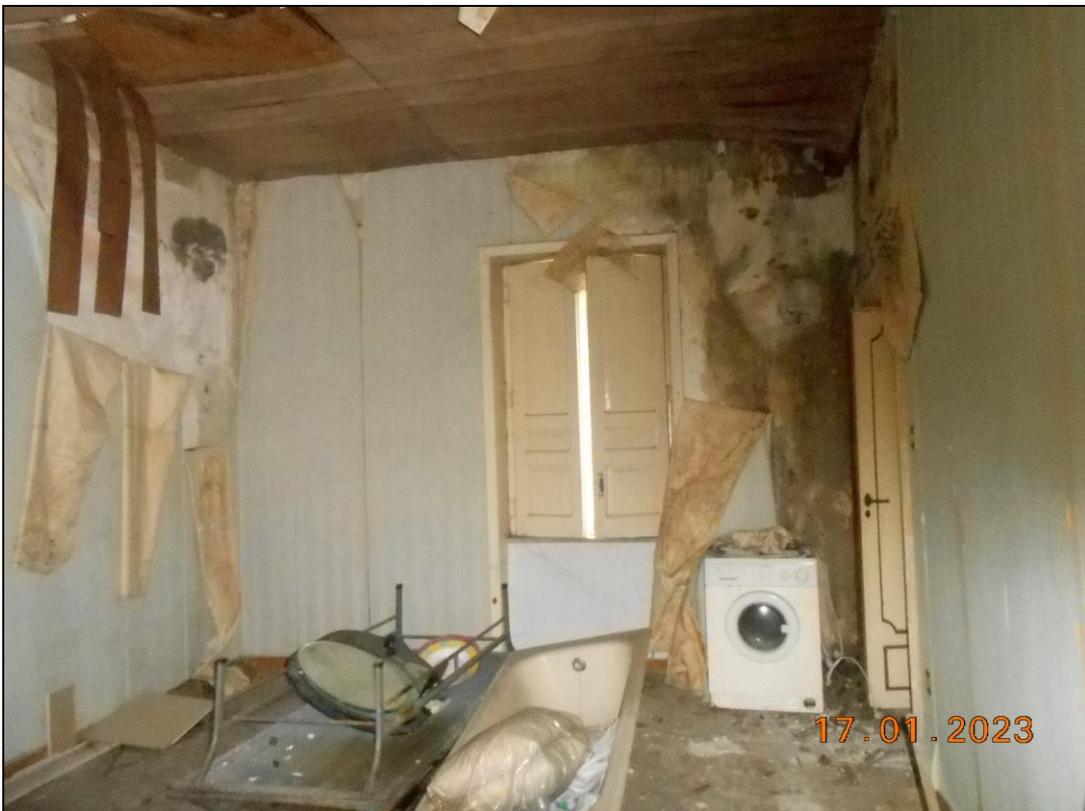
Vista interna del piano primo. Si notano le diffuse infiltrazioni d'acqua sul soffitto e pareti.
